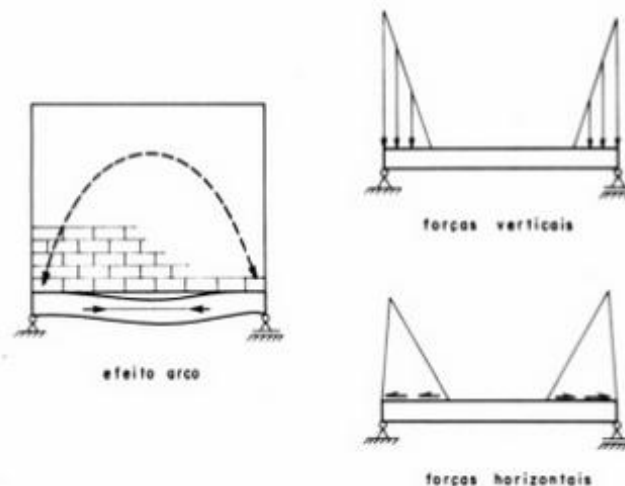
Parede sobre viga- ação alternativa (PARSEKIAN, 2013)
